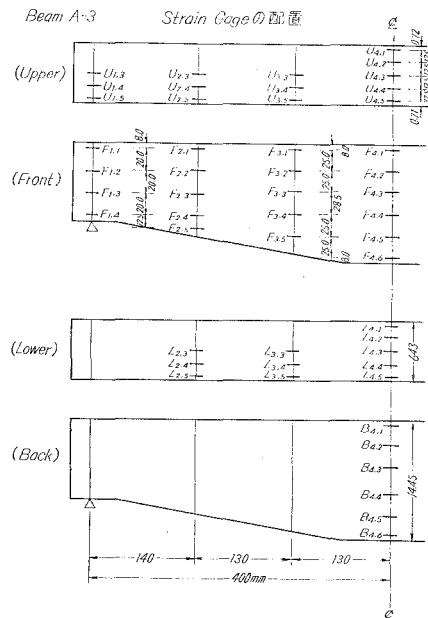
鋼箱桁模型 Beam A-3 のゲージの位置
